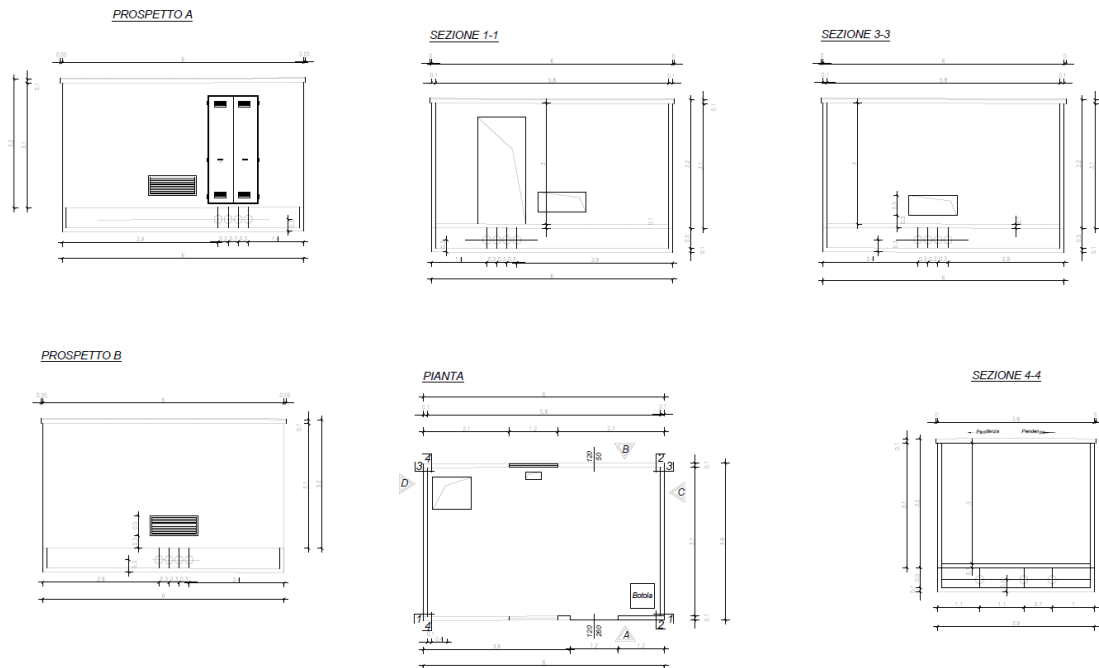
prospetti, sezione e pianta delle cabine di sottocampo.
